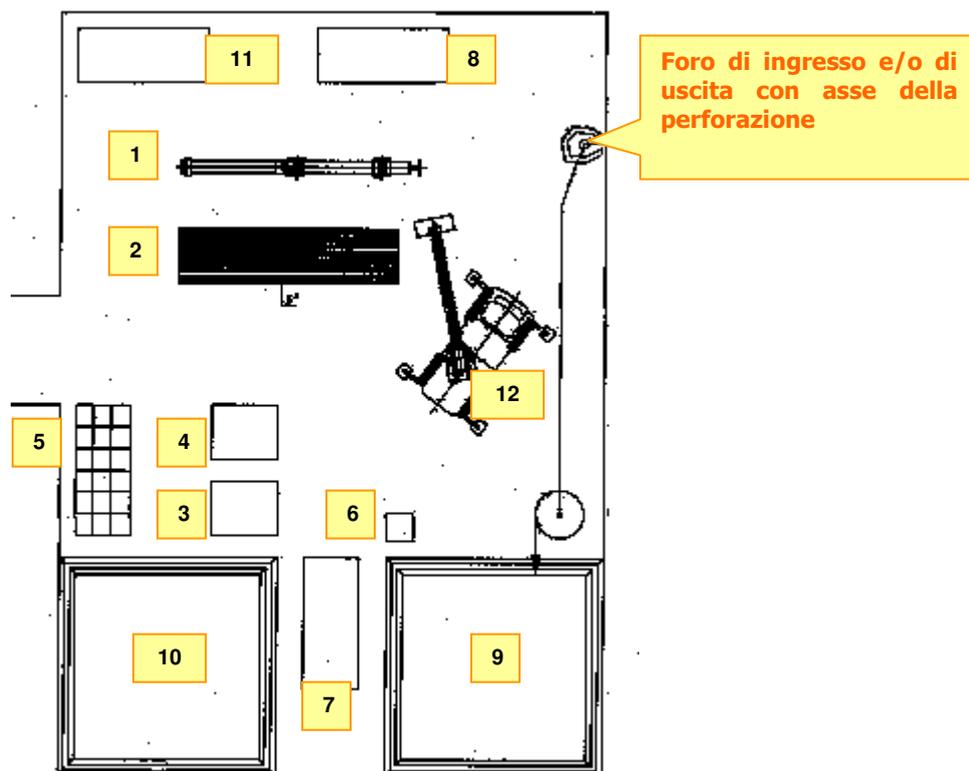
Stralcio planimetrico relativo ad un'area di cantiere tipo per la realizzazione di una TOC.
